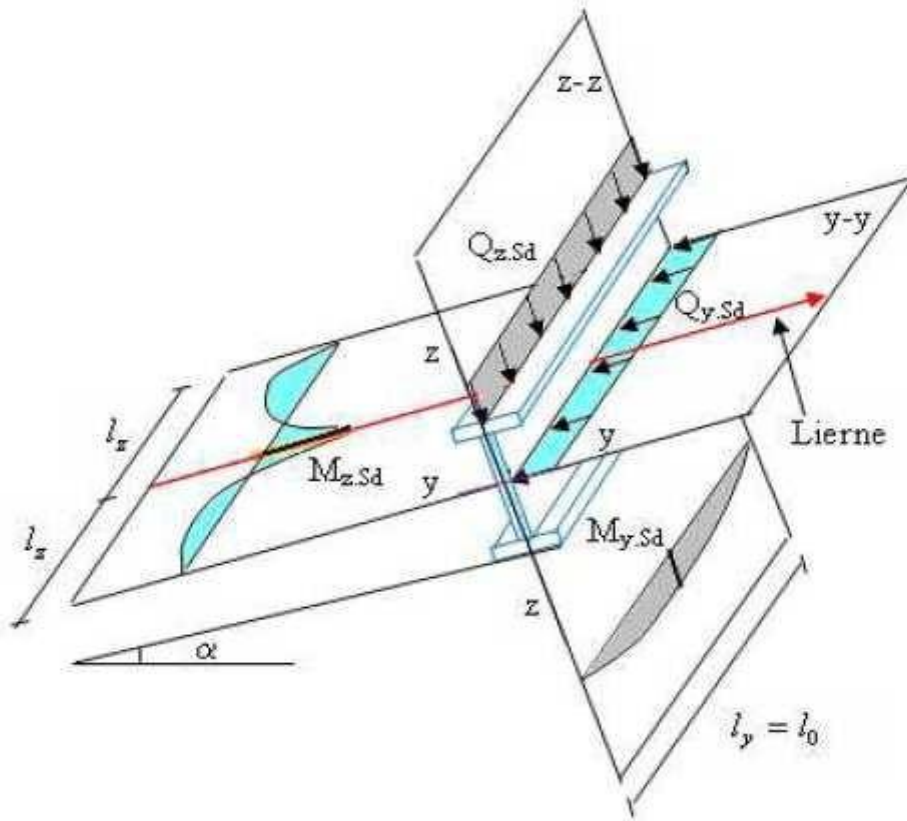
Panne de toiture en flexion sous les différents plans de chargement.
